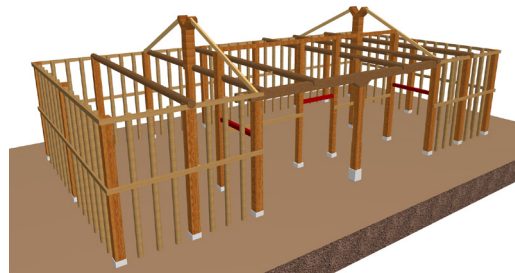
Detalle, armado de parantes, pilar, capitel y solera
